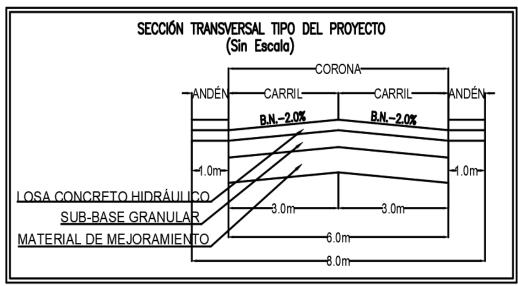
Sección Transversal Típica del Proyecto. Fuente: Citec Ltda.
